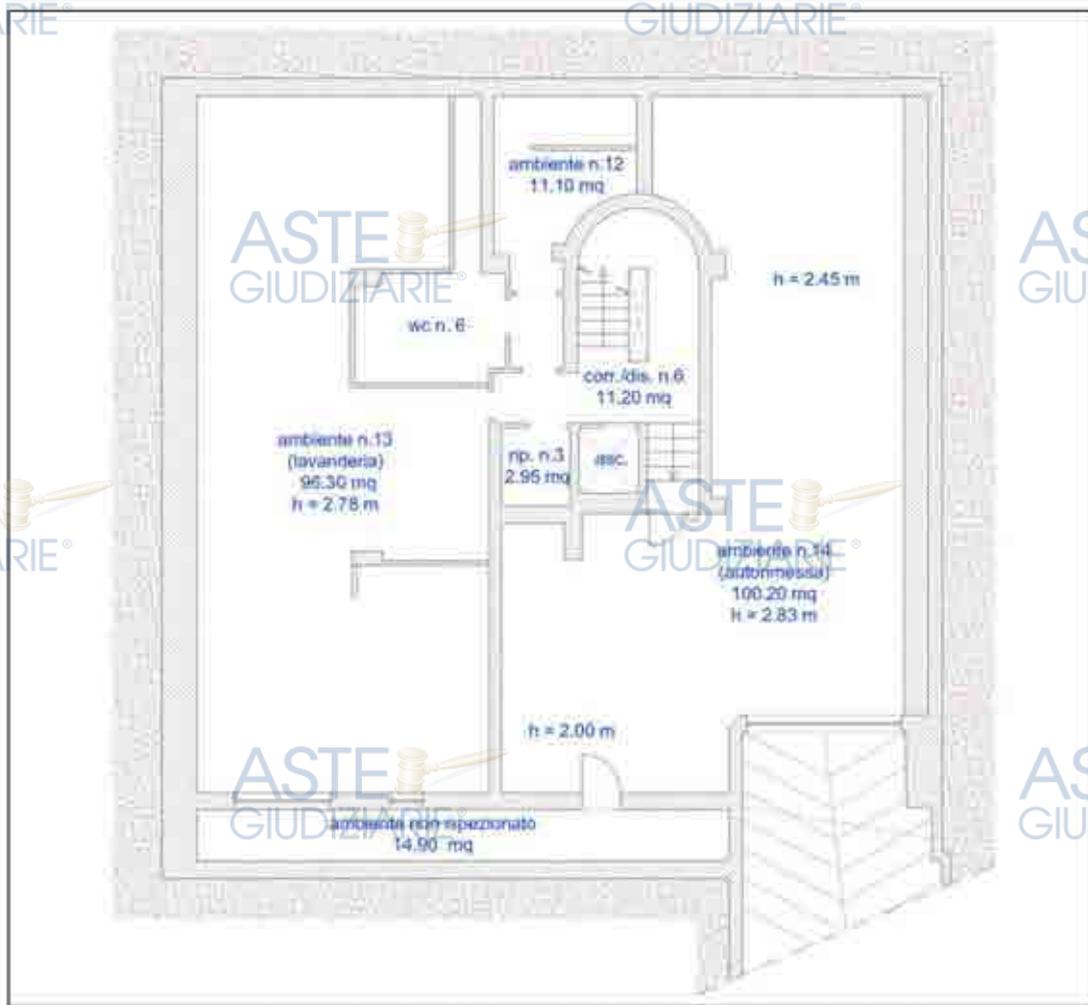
Planimetria piano seminterrato - 17/06/2021
